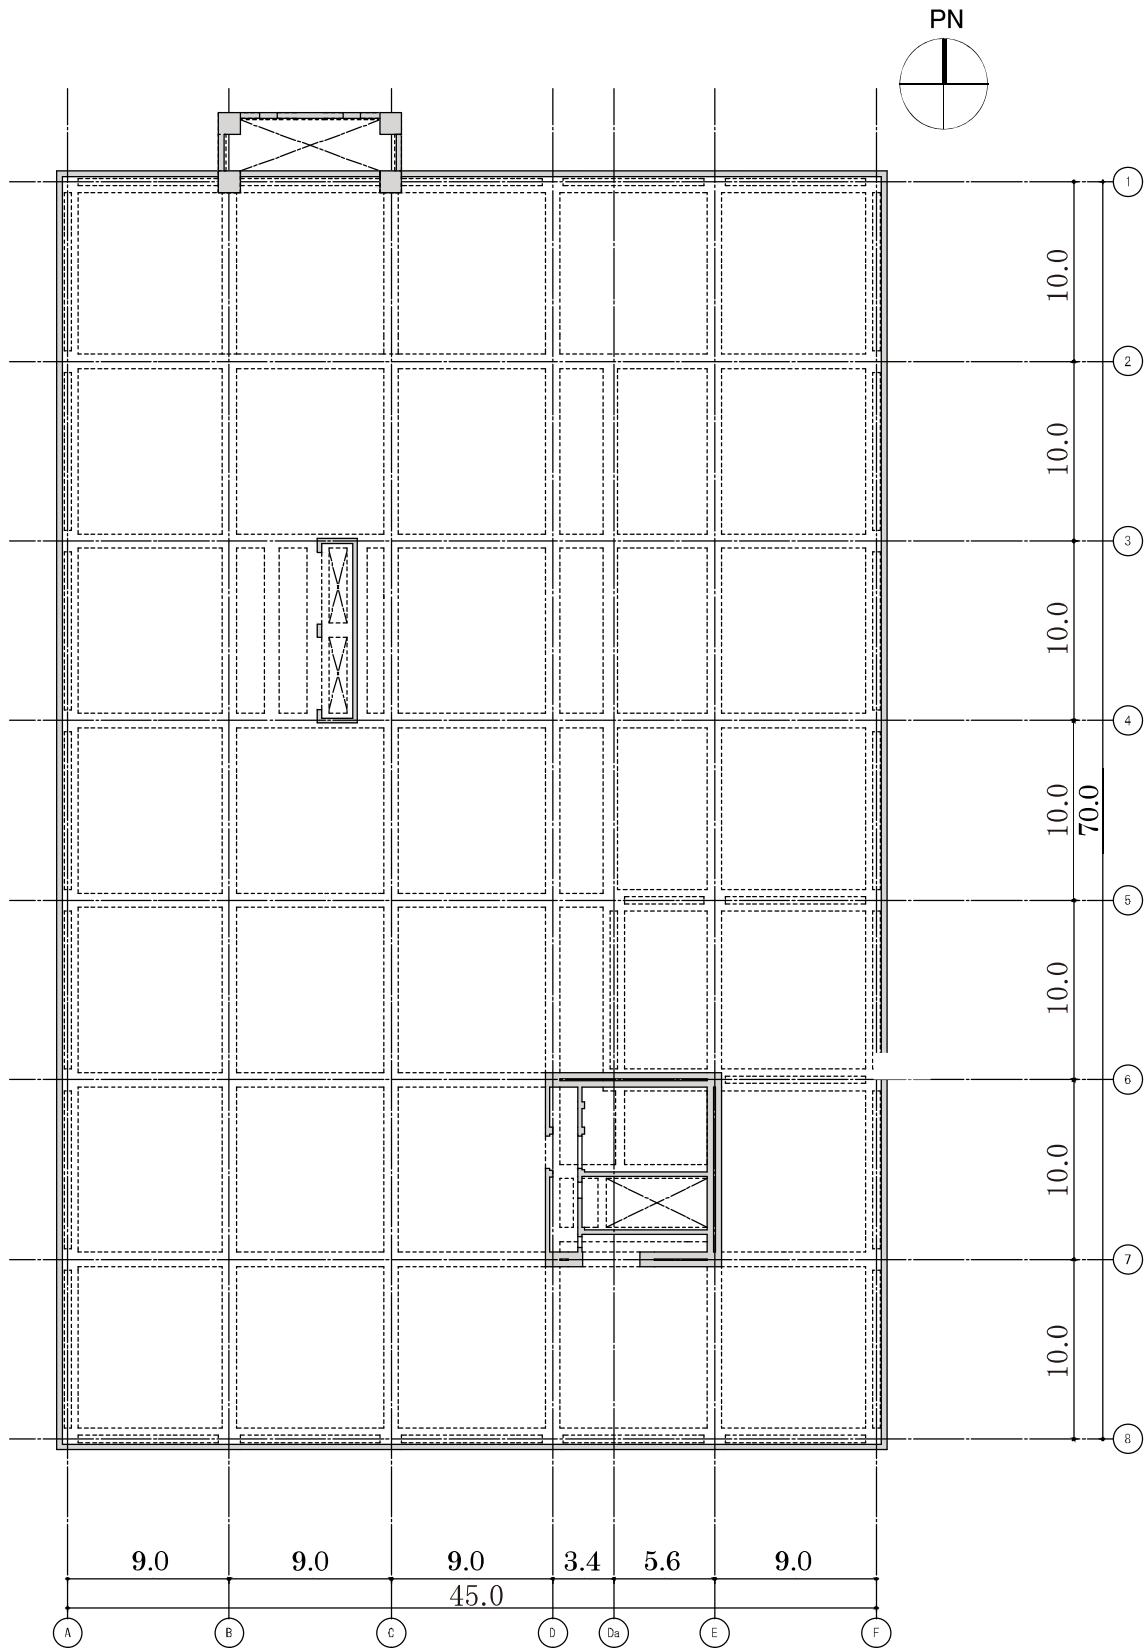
屋上階平面図 (G. L. +24. 30) (单位 : m)
